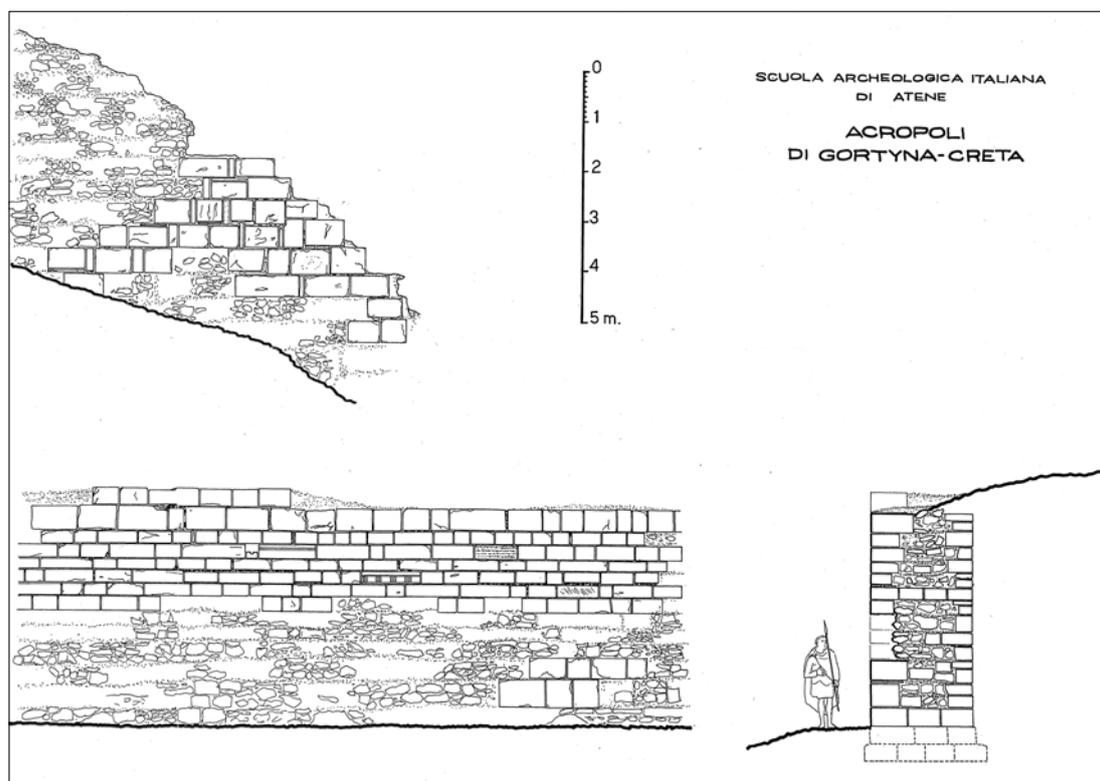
Tratto di cortina 6.4, prospetto est e sezione (ADS n. C7/421).
